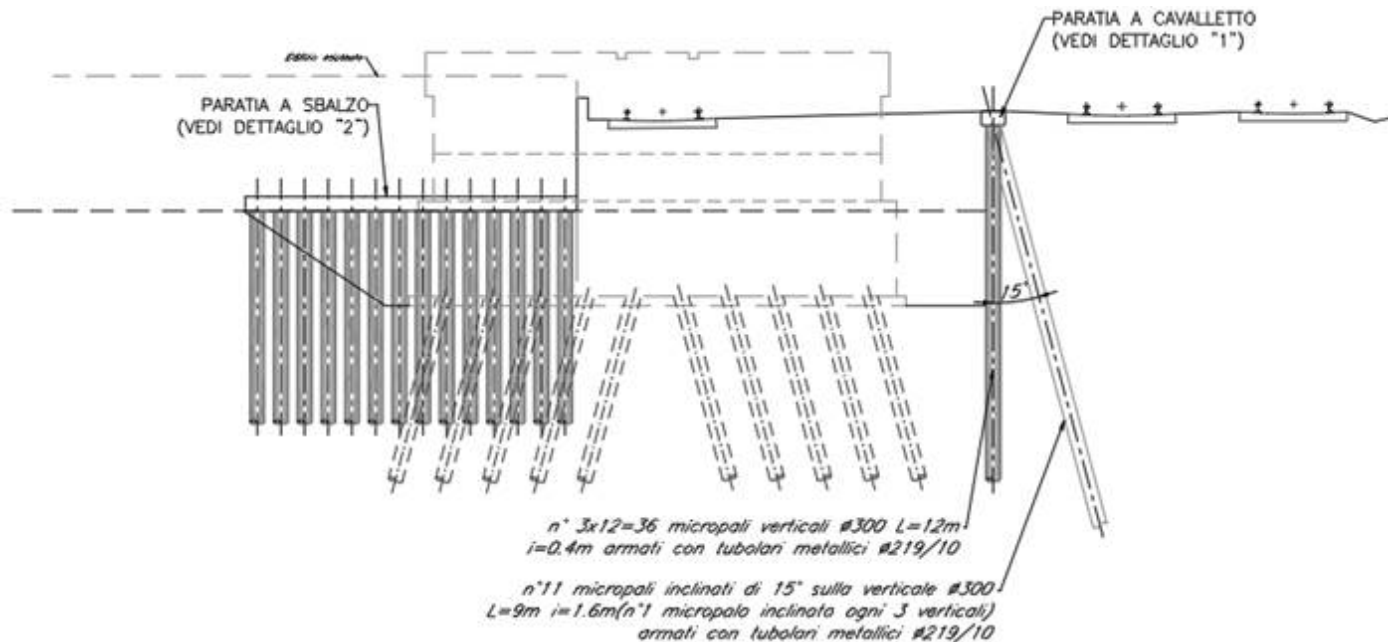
Sezione Opere Provvisionali Spalla B
